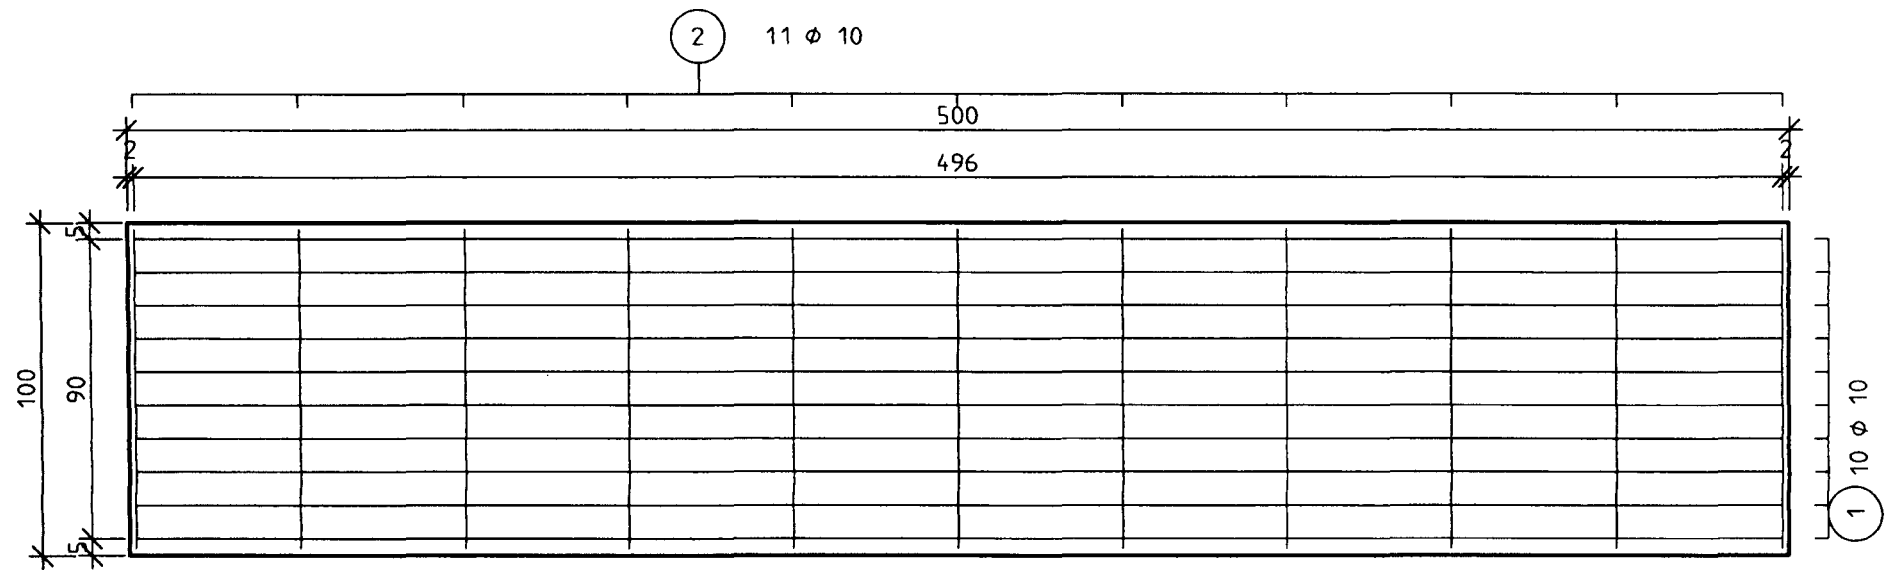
obere Bewehrungslage des Versuchskörpers V 2
